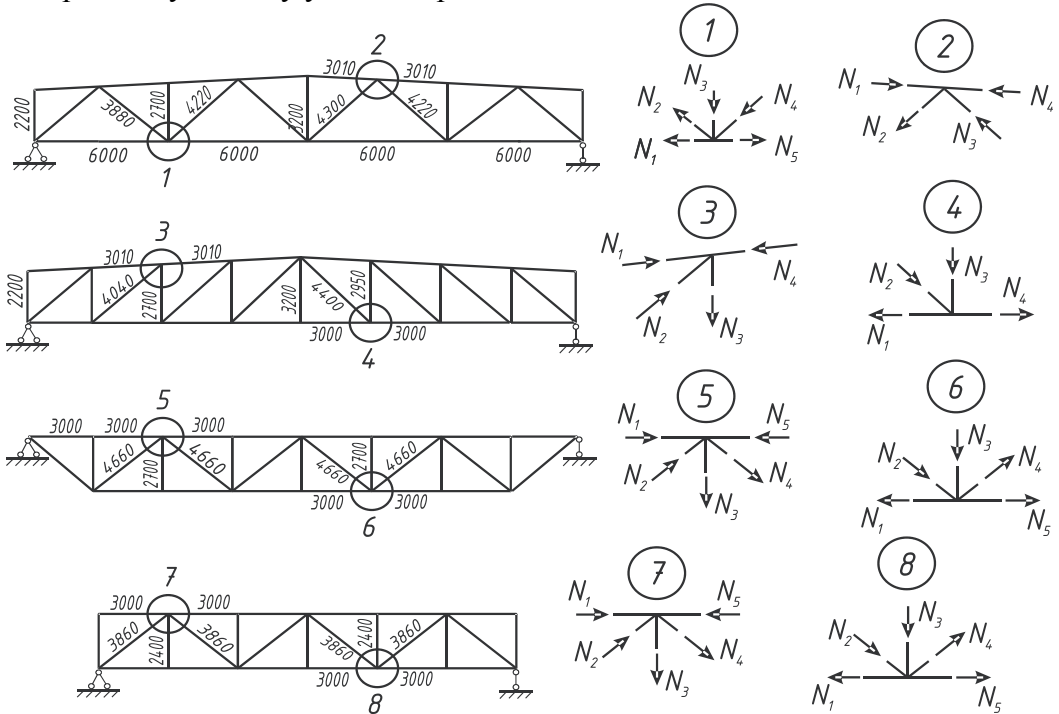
Геометрические схемы ферм и расчетные схемы узлов
